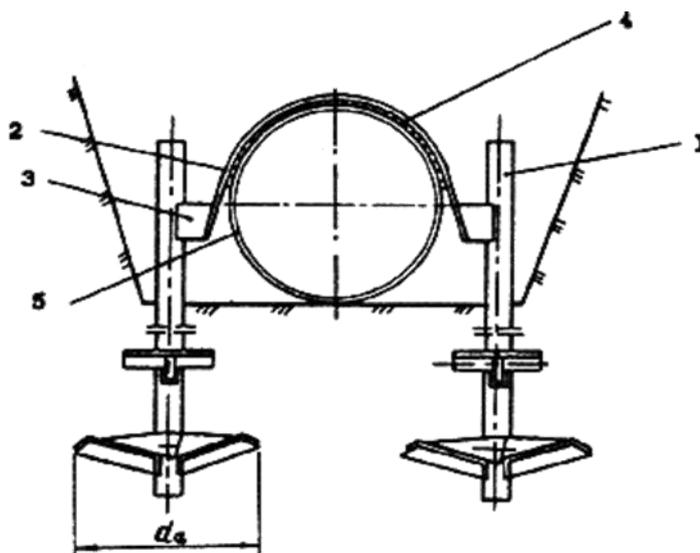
Схема конструкции раскрывающегося анкерного устройства типа АР-401: 1 - анкер раскрывающийся; 2 - прокладка; 3 - хомут; 4 - мат; 5 – трубопровод
